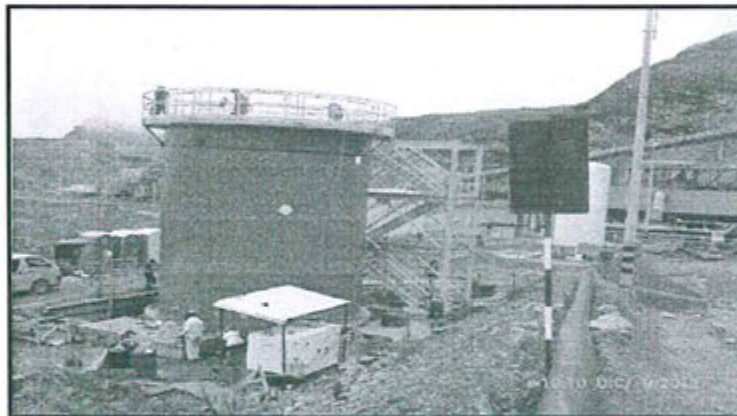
Observación N° 12-2012. Se verificó que el titular minero se encuentra construyendo una planta de tratamiento de aguas dentro de su Plan Integral de Adecuación sin haber sido autorizado.
